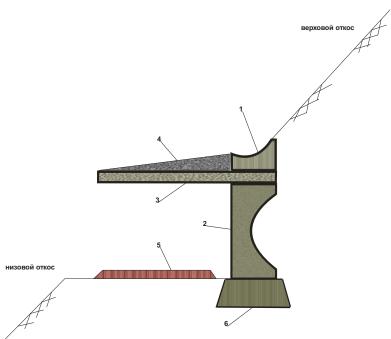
Новое конструктивное решение галереи: 1 — трамплин; 2 — подпорная стена; 3 — перекрытие; 4 — амортизационный слой; 5 — дорожное полотно; 6 — фундамент подпорной стены.
